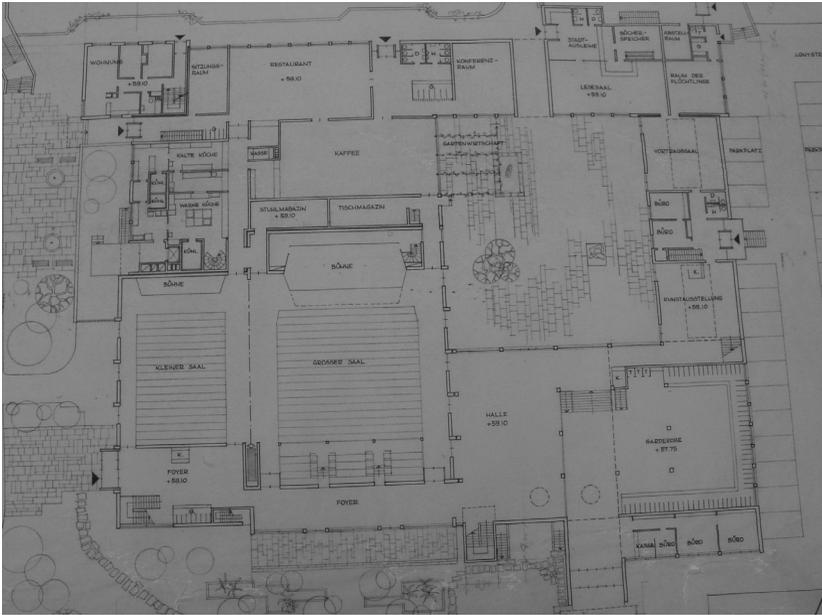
Sven Markelius: Erdgeschoss-Grundriss des Bürgerhauses für die Stadt Gießen. Dritter Vorschlag, datiert 17.07.1961 (SHG).
